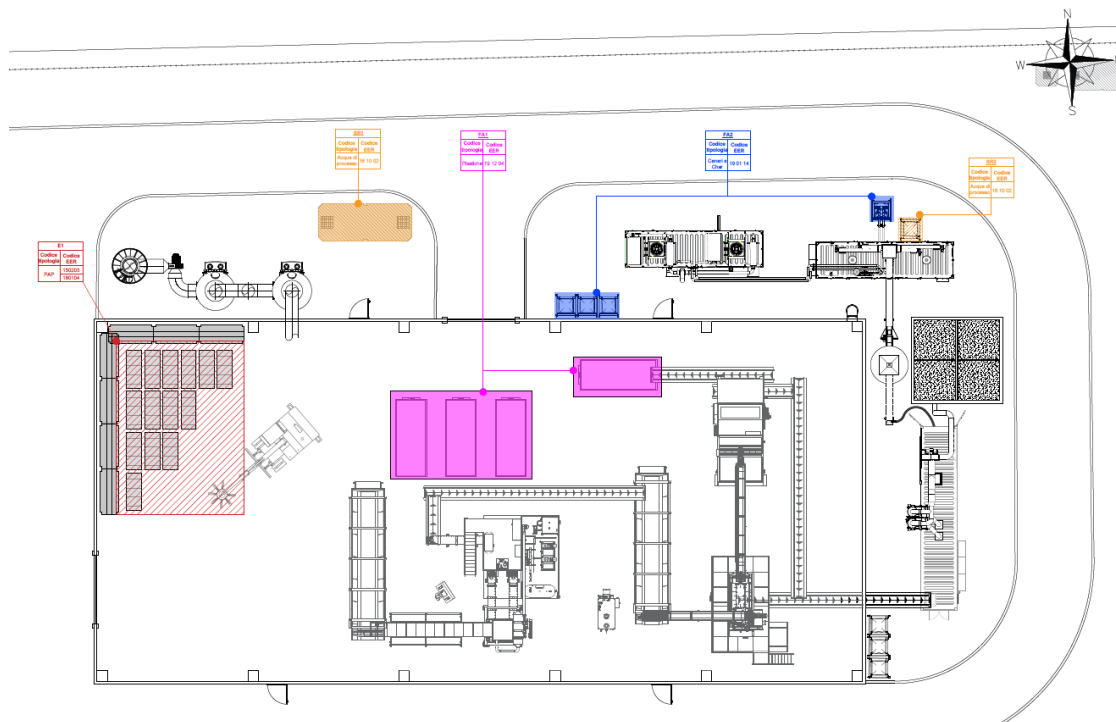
Stralcio della tavola PFTE_EGR_PRO_004 Planimetria aree stoccaggio rifiuti IN-OUT
